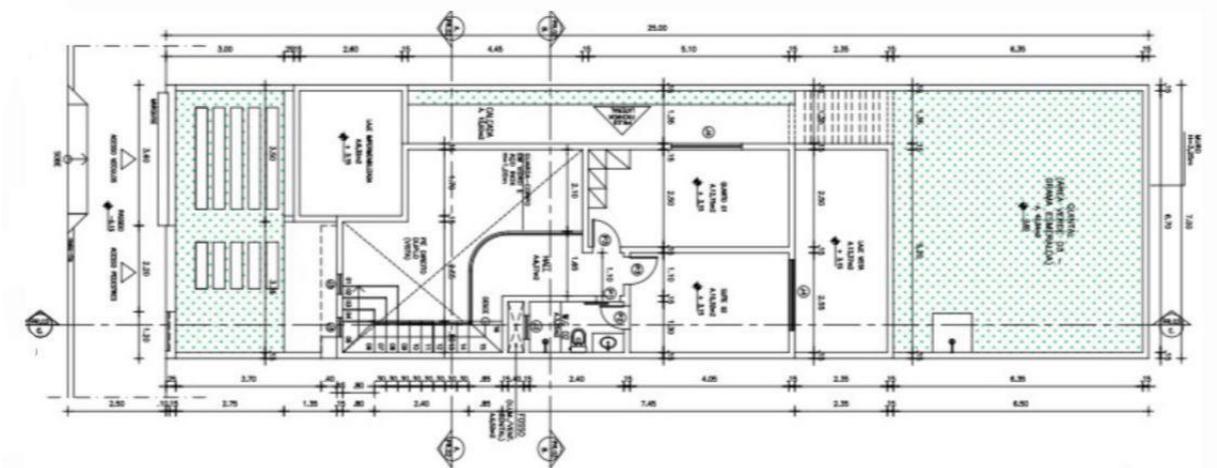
Planta Baixa Obra 02 - Pavimento 1
